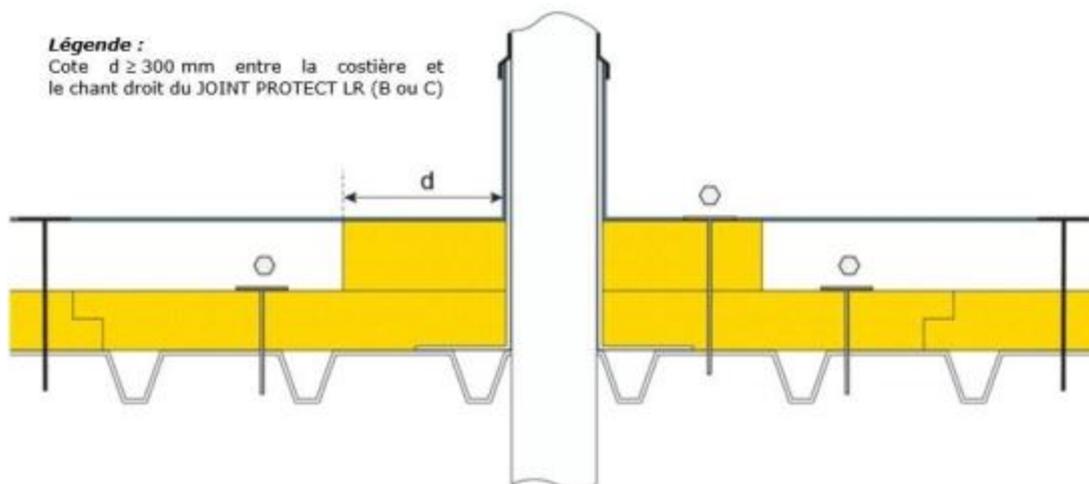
Exemple de traitement pour la traversée d'un conduit
